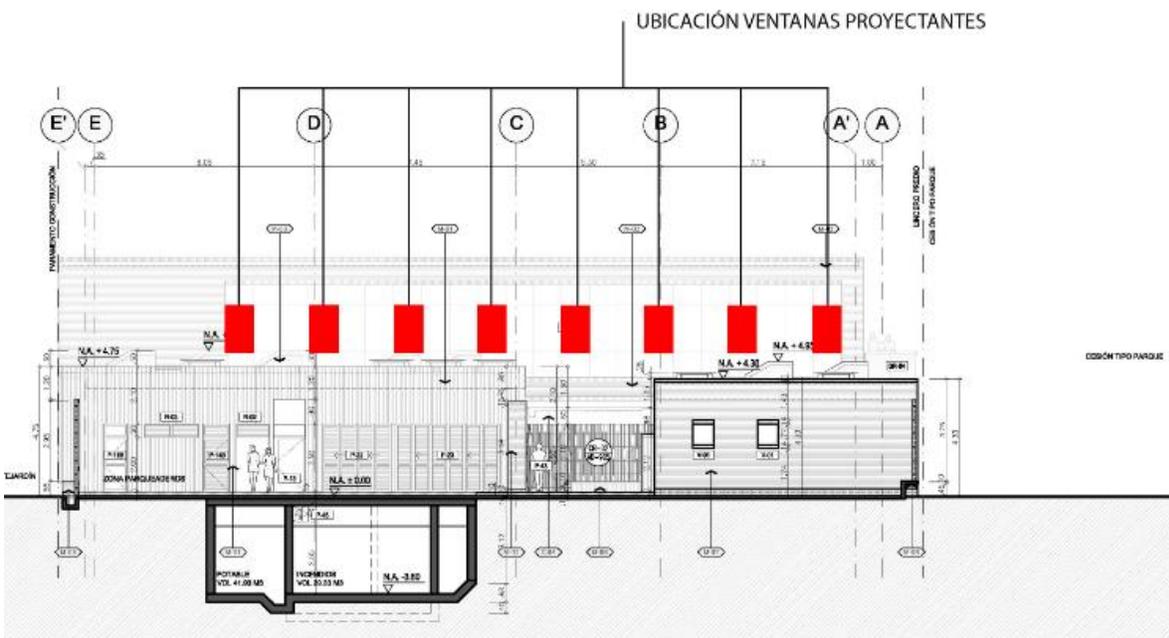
Localización aperturas en segundo piso- fachada norte A-302 Anexos
